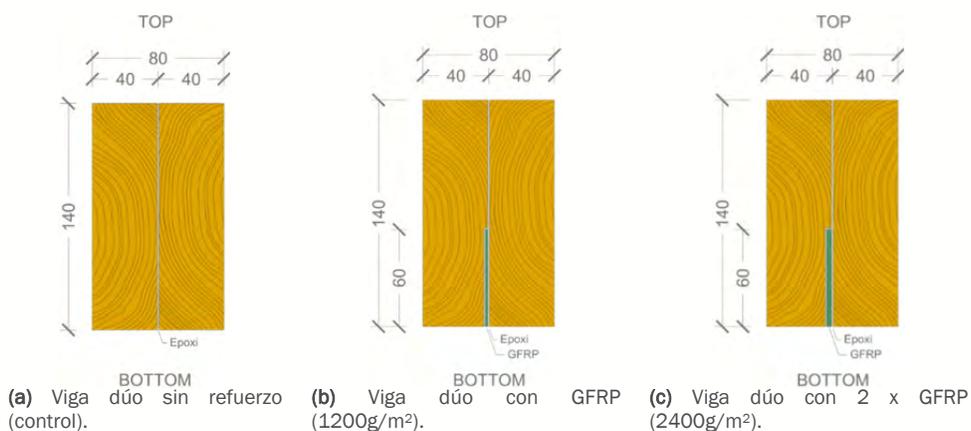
Sección transversal de las piezas dúo control y encoladas con GFRP
